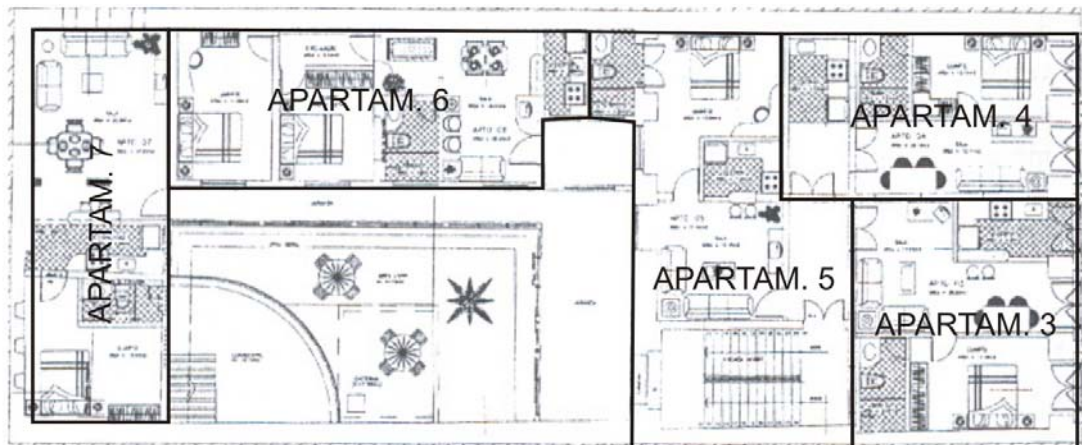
Sobrado à rua do Giz, 117 – Planta baixa do primeiro pavimento (LIMA et al, 2004, p. 129, adaptado pela autora).
